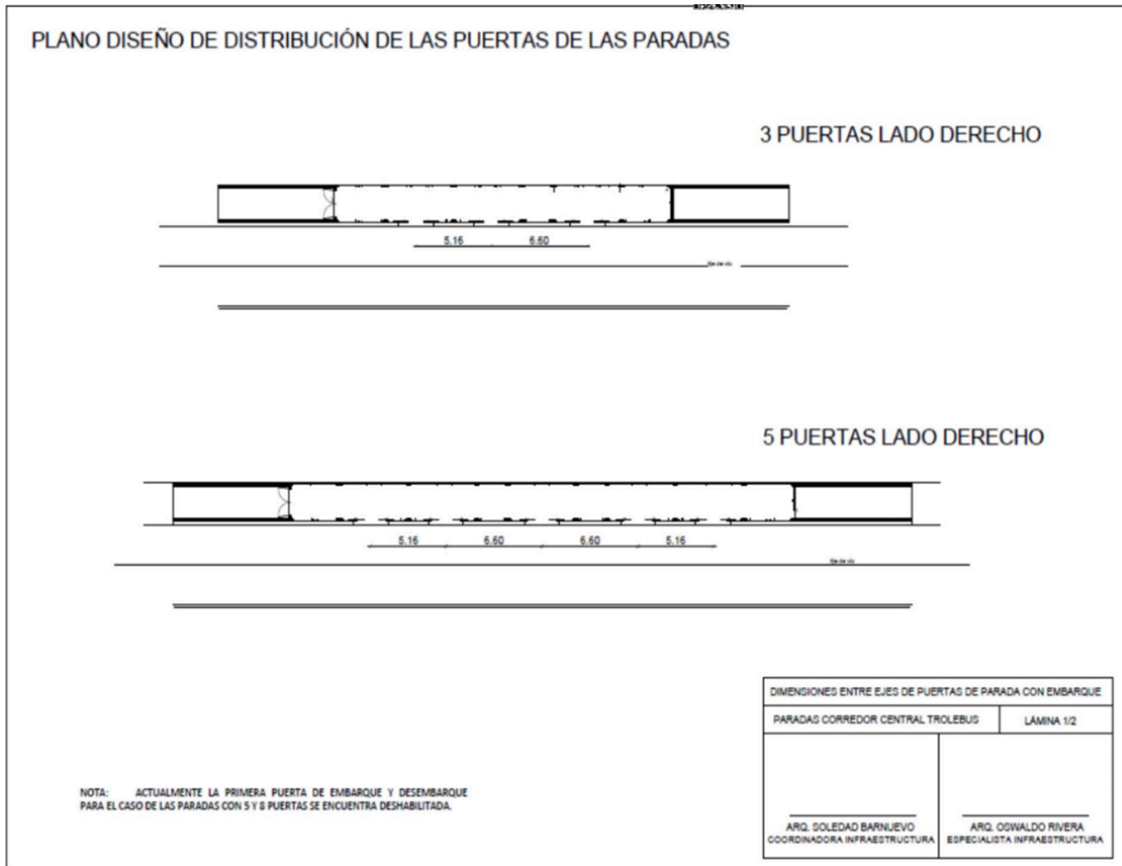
Paradas (estaciones) con 3 y 5 puertas ubicadas a lado derecho
